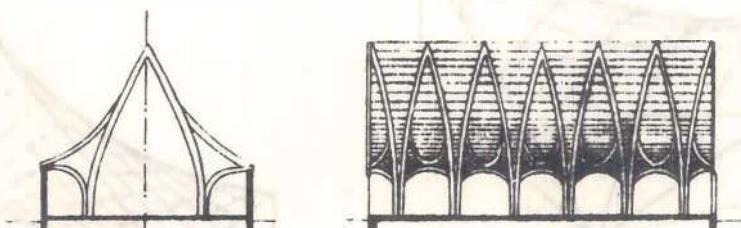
Distintos tipos de elementos estructurales en madera laminada.
